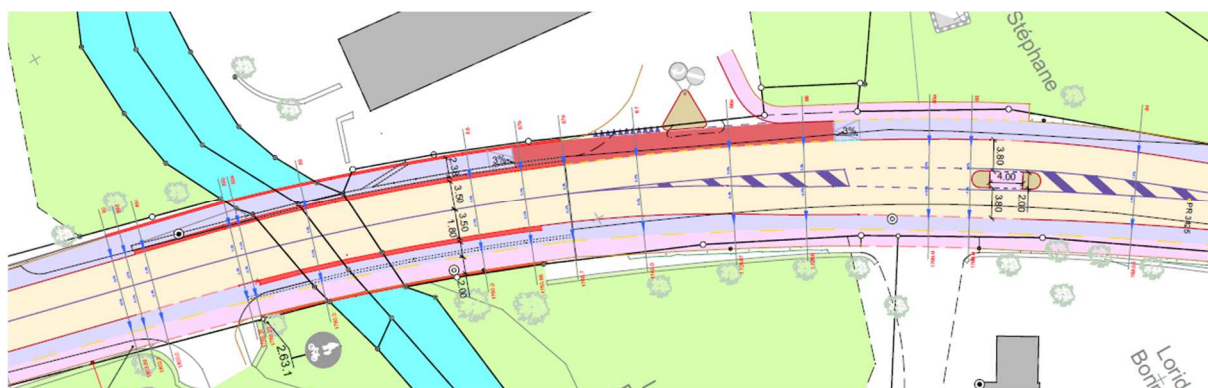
Situation d'aménagement du secteur du pont sur la Promenthouse
